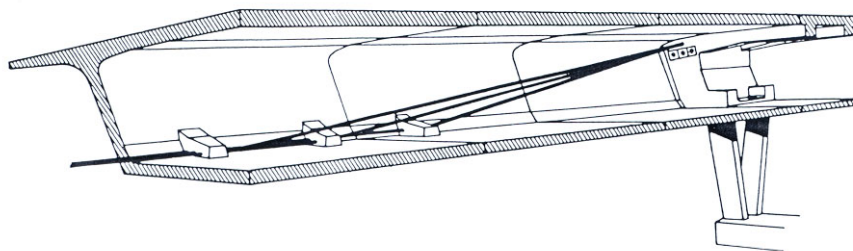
Long Key Bridge. Disposición del pretensado exterior
